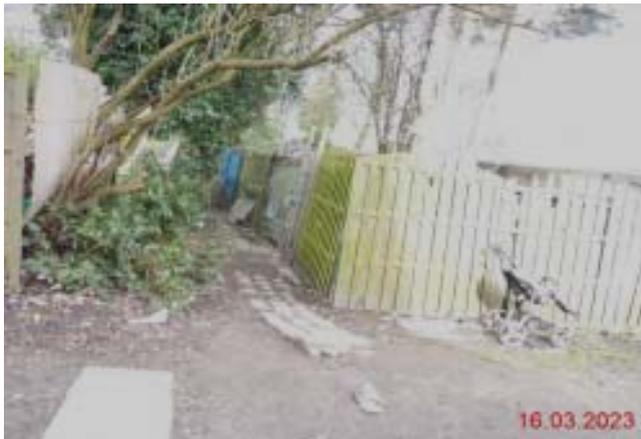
zurückzubauende Parzellen im rückwärtigen Grundstücksbereich
